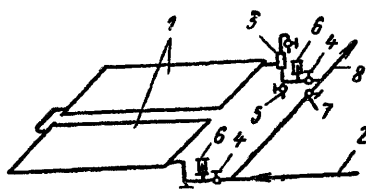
Схема присоединения напольных панелей к водяной системе отопления
